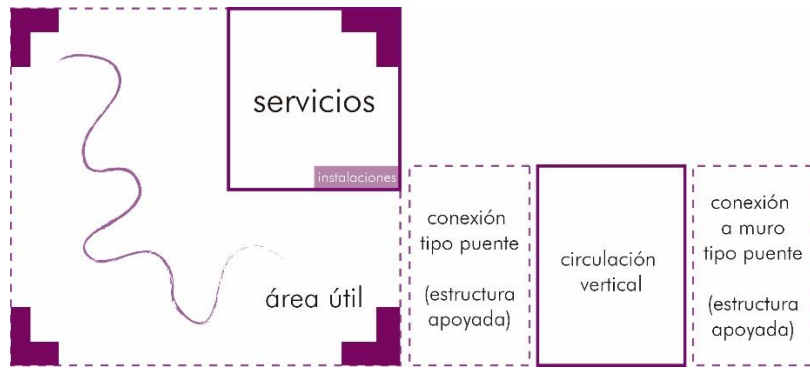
Esquema de estructura en planta. (Elaborado por: Jaire Cagigal)
